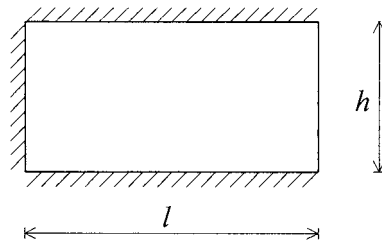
Mur maintenu latéralement en tête et en pied et sur une rive verticale
